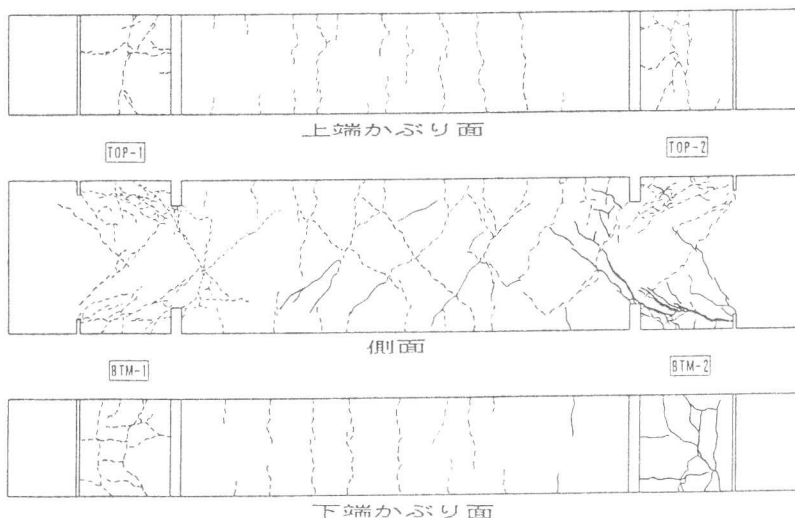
最終ひび割れ状況図 (試験体 No. 2)
